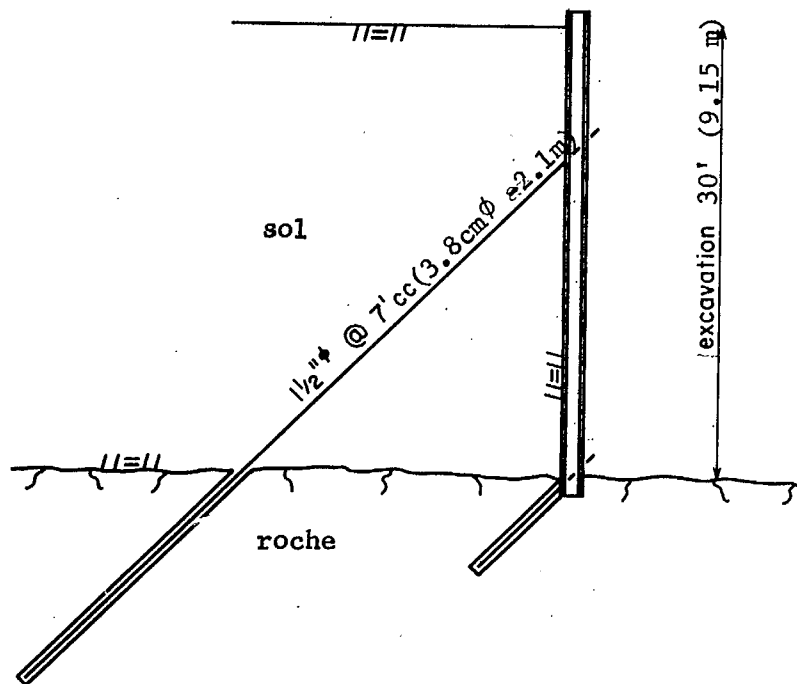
Ancrage au rocher utilisé dans la construction de murs de soutènement.
